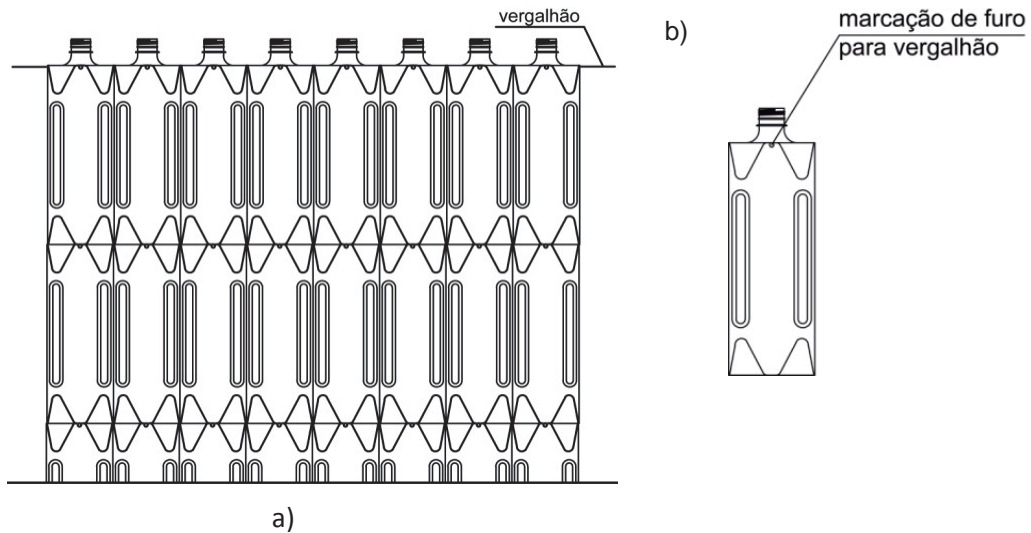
a) Construção da Parede passando o vergalhão na terceira fileira b) Indicação do local onde se deve fazer o furo para passar o vergalhão.
